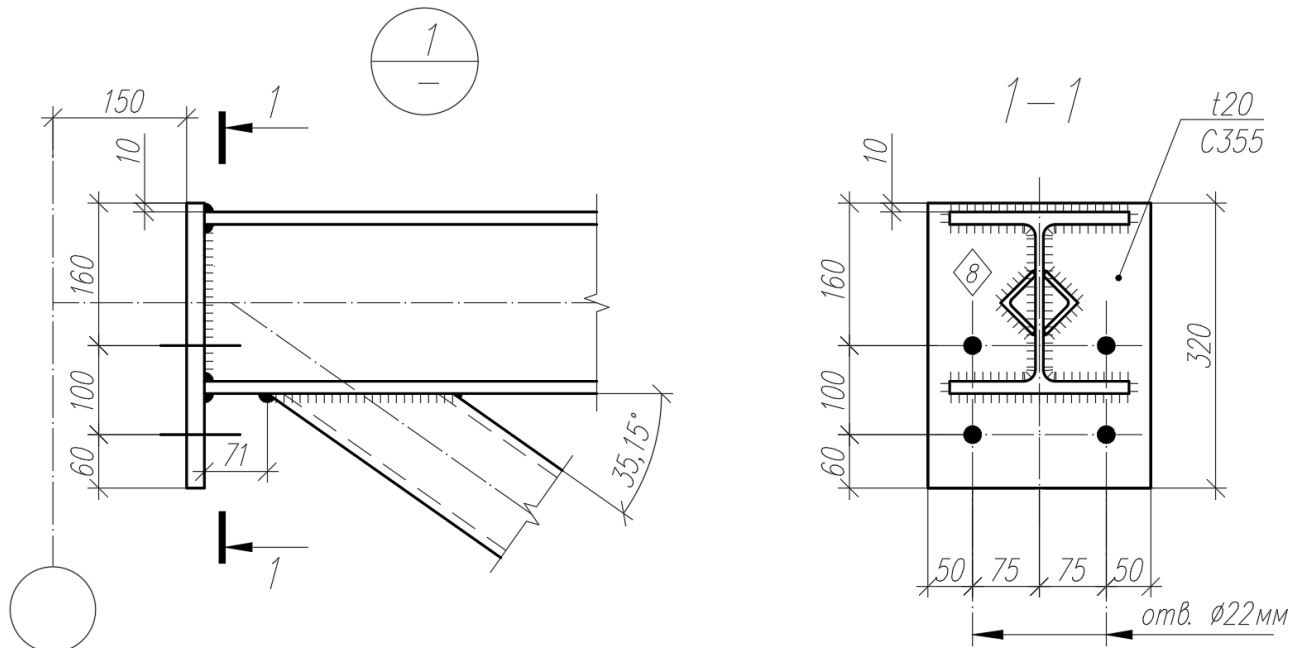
Узел 1 подстропильной фермы ФП-12-71,2.
